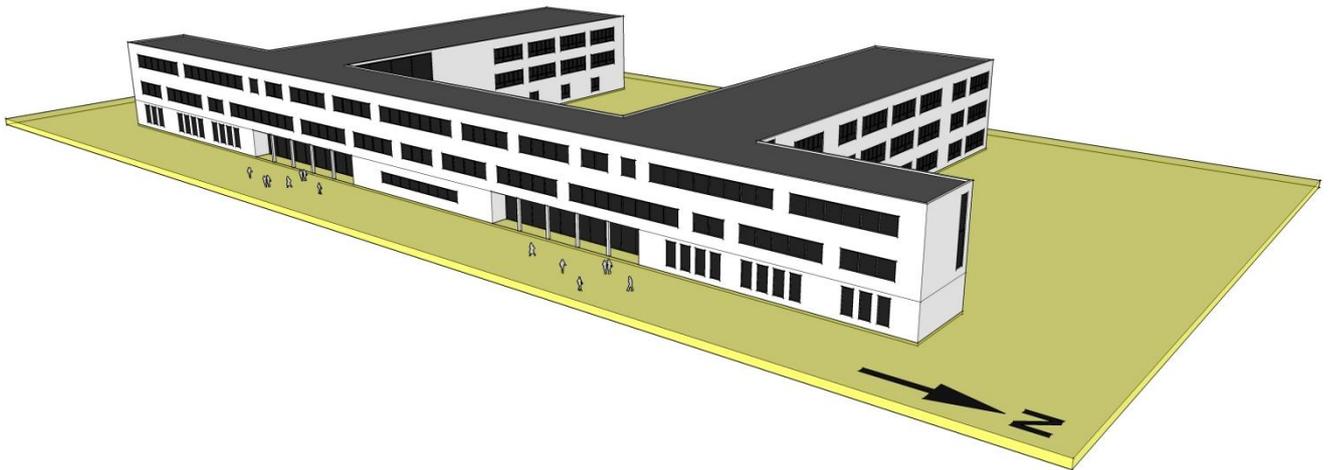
Schulen - groß - Darstellung Gebäude - Ansicht Nord-Ost
